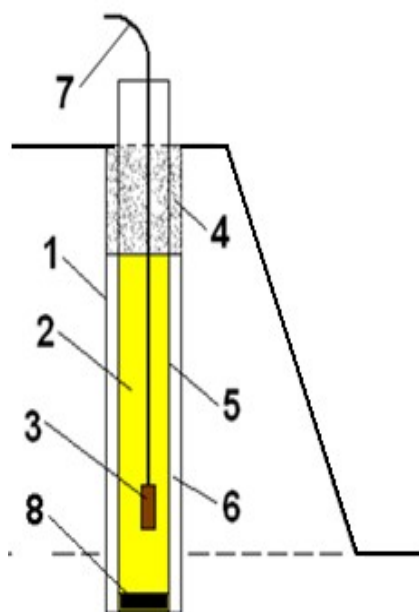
Конструкція свердловинного заряду з інертним зазором між ВР і стінками свердловин (породою): 1 – свердловина; 2 – ВР; 3 – проміжний детонатор; 4 – набивка; 5 – рукав (поліетиленова оболонка); 6 – інертний зазор; 7 – ДШ; 8 – обважнювач
